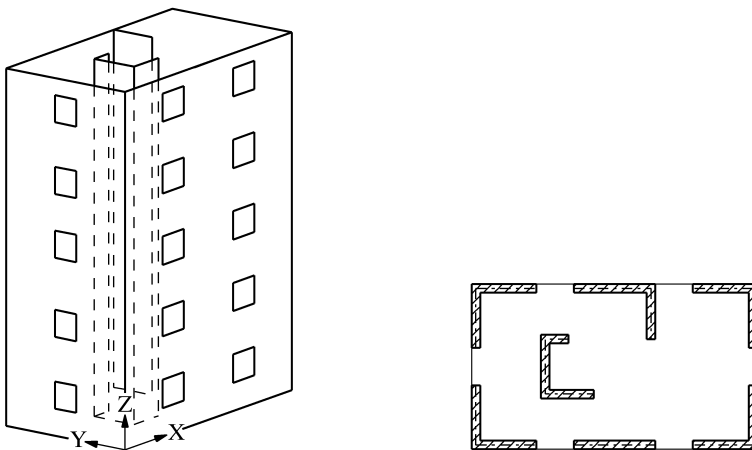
Mehrgeschossiges Gebäude und Grundriss des Gebäudes
